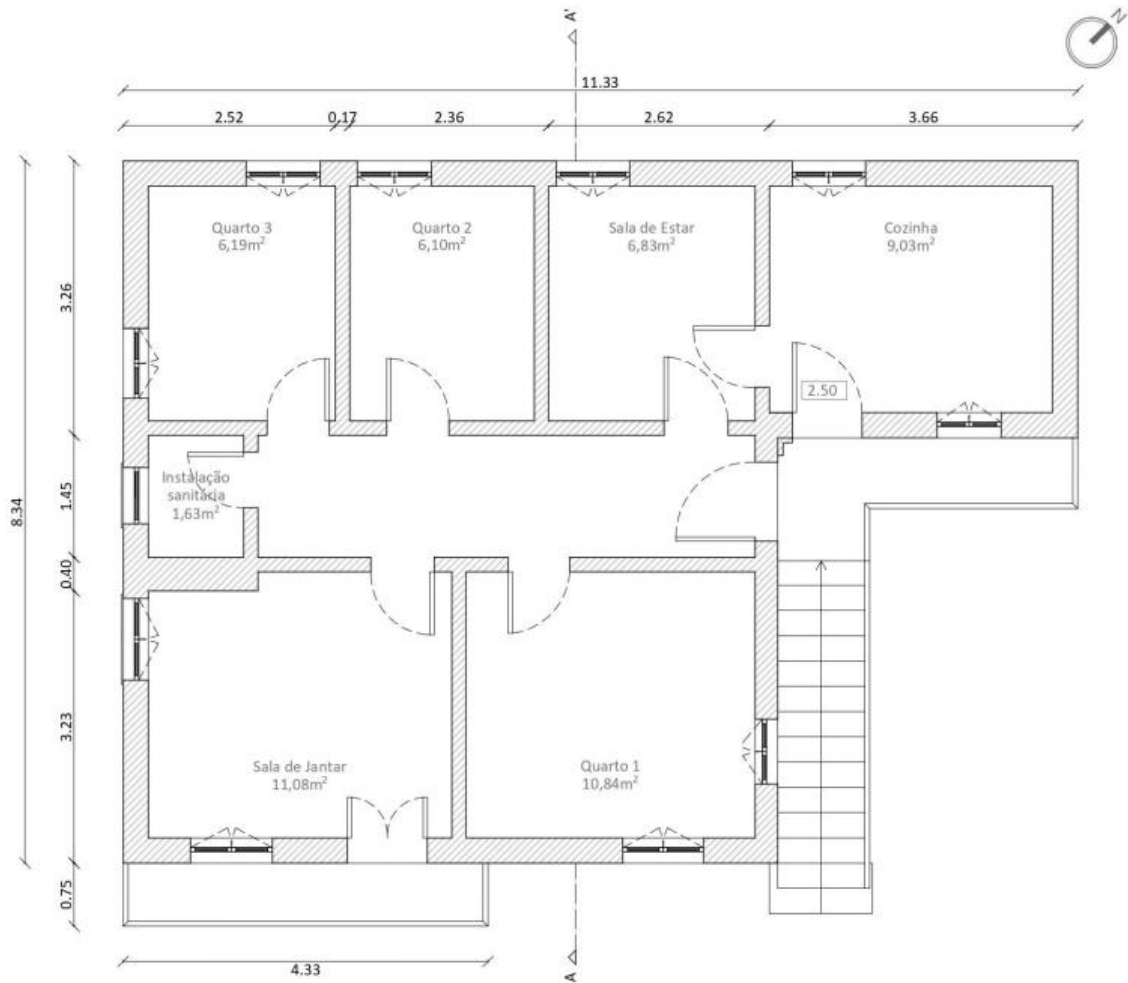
Planta de Levantamento do Piso 1. Fonte: Autor
